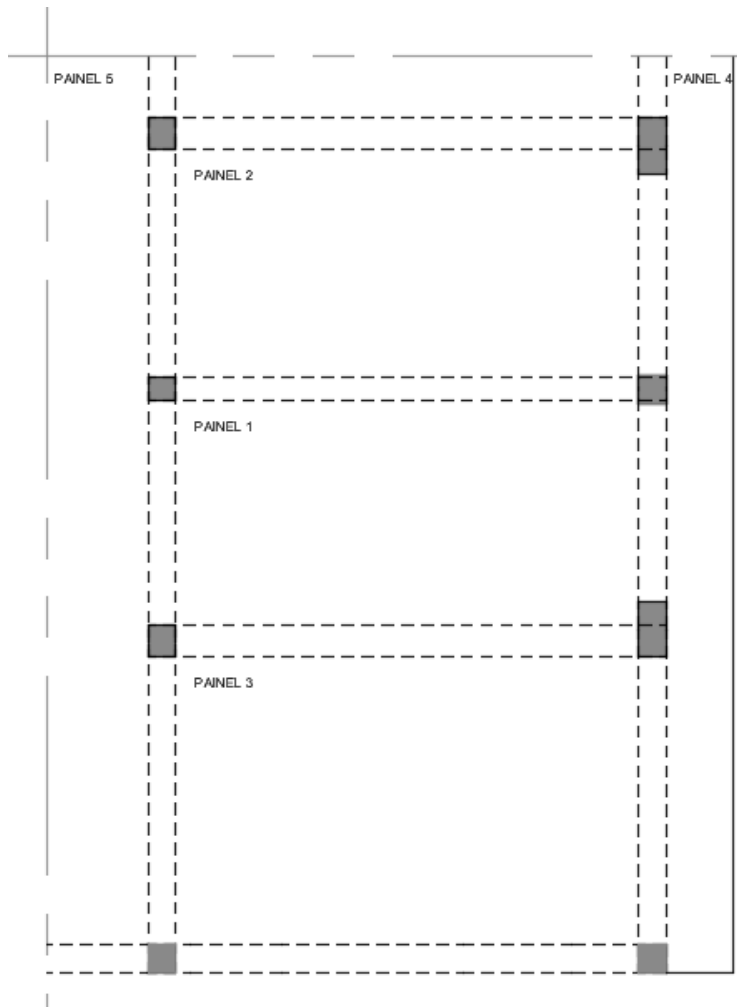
Planta simplificada dos painéis de laje de pavimento
